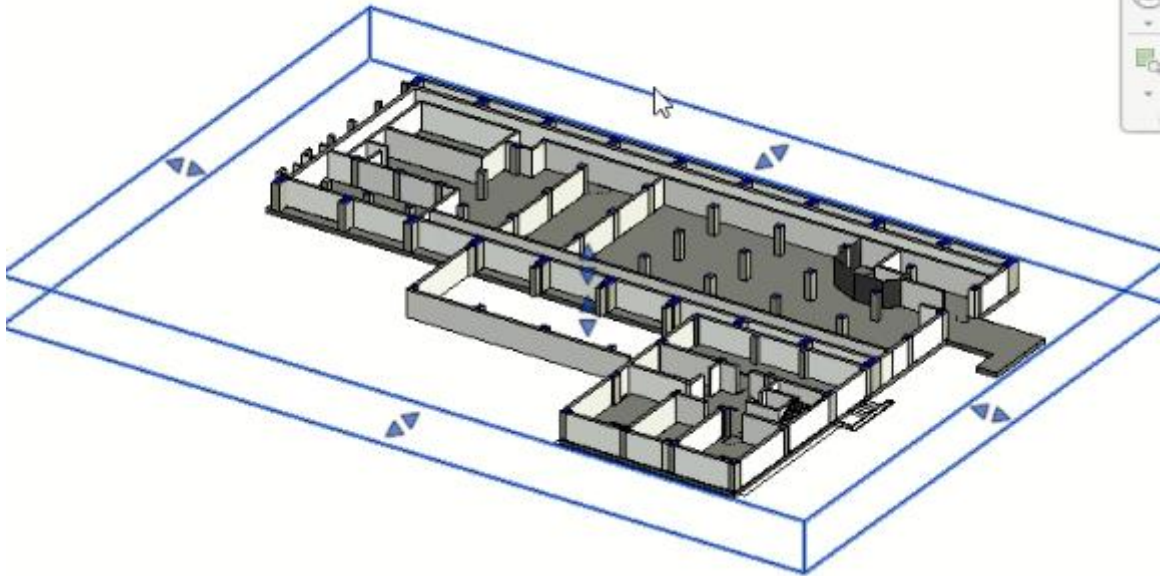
Mampostería interior del subsuelo Edificio 10 en Revit.
